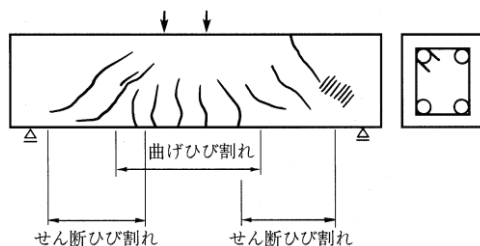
コンクリートのひび割れ発生の概念⁶⁾
